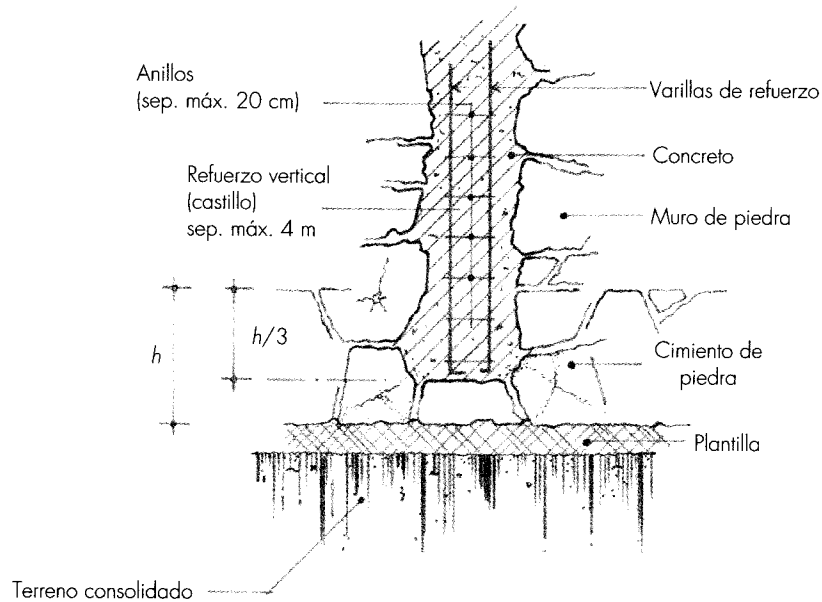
Corte longitudinal que muestra el castillo de concreto armado anclado en el cimiento de piedra.
